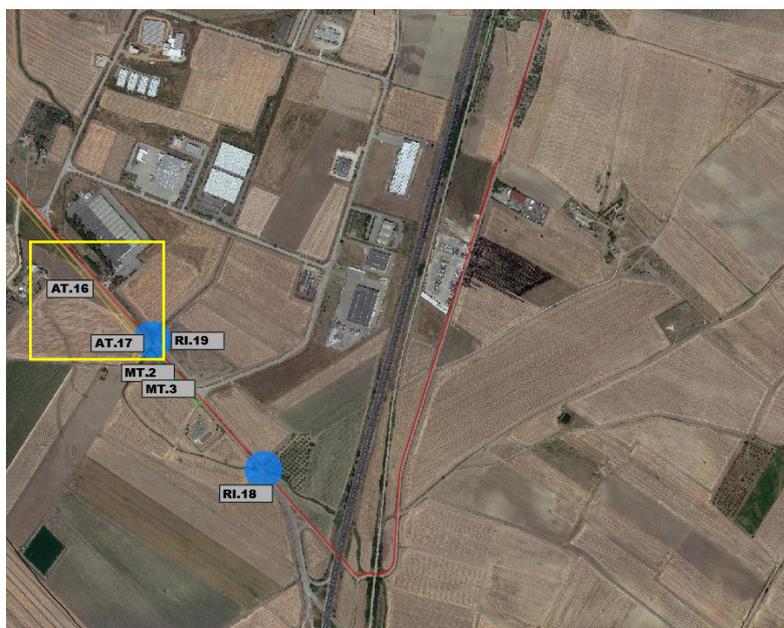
Estratto per l'Individuazione Planimetrica Interferenze Linee AT (AT.16 e AT.17) del Cavidotto Esterno su Ortofoto
